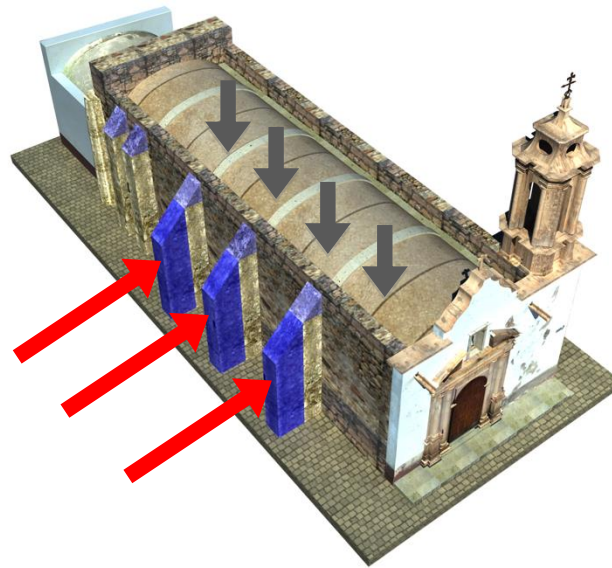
Construcción de Contrafuertes de adobe en fachada poniente
